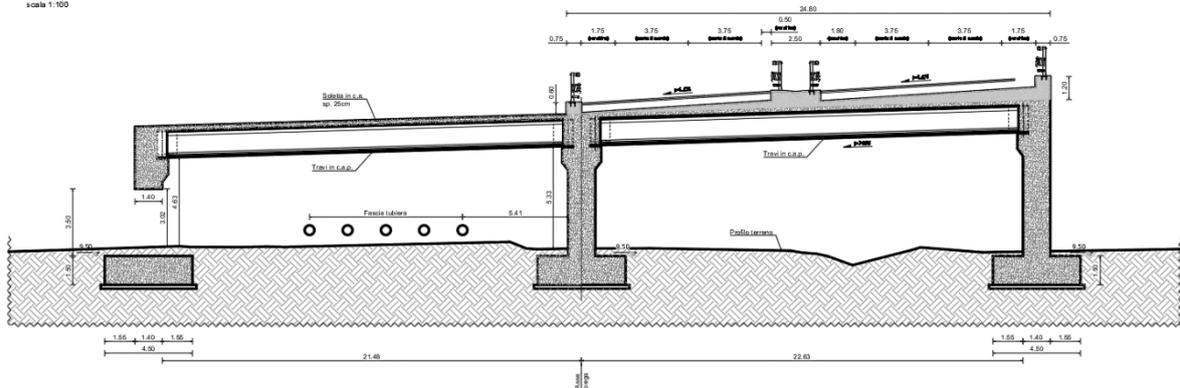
Sezione C-C trasversale opera trasversale scavalco fascia tubiera alla prog. 8+366.00.
